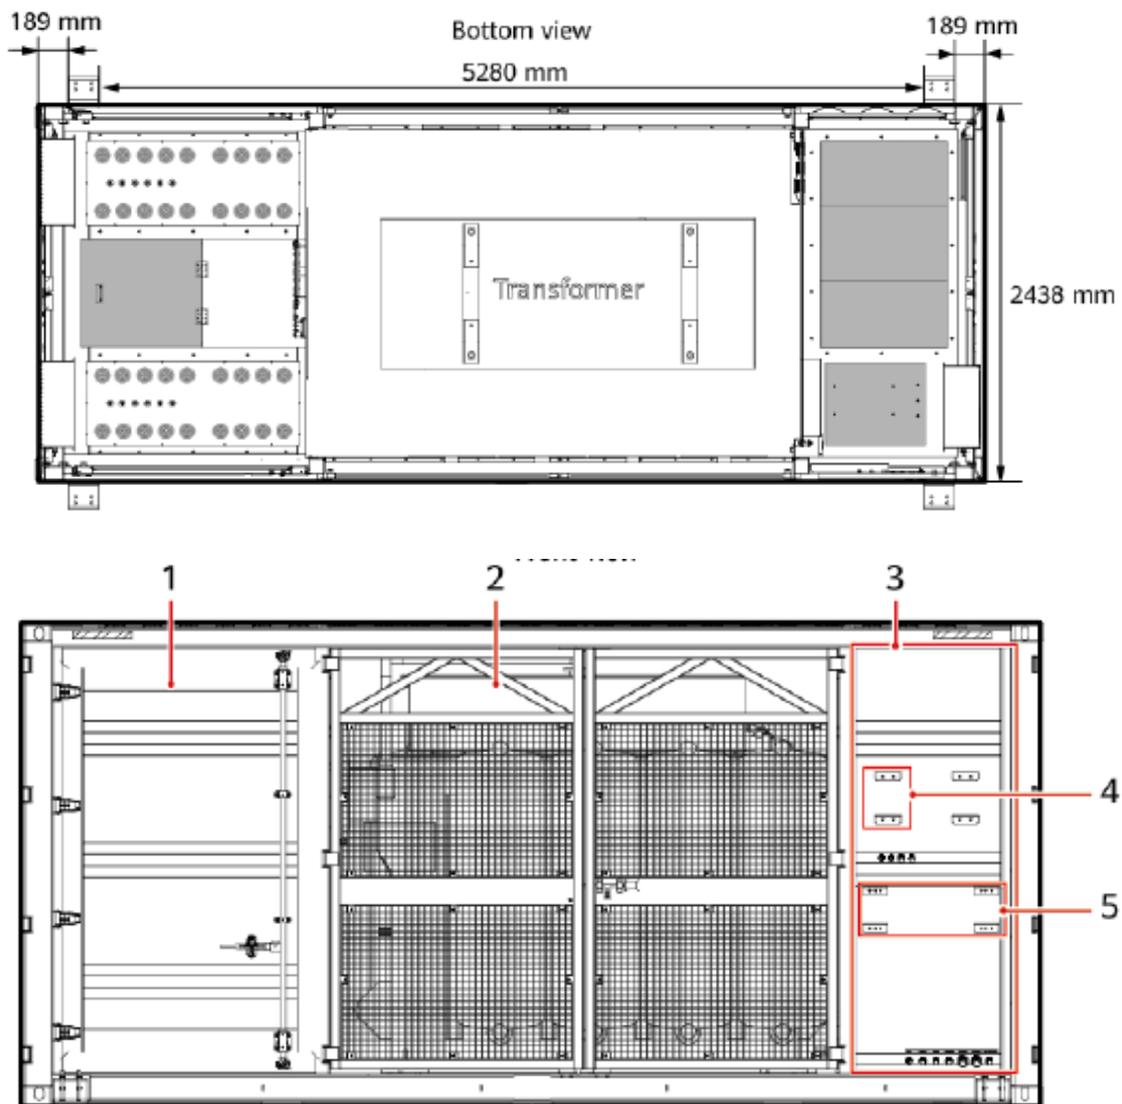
Planimetria e prospetto tipo dell'unità di trasformazione, con 1=Locale Bassa Tensione; 2= locale trasformazione; 3= locale Media Tensione.
